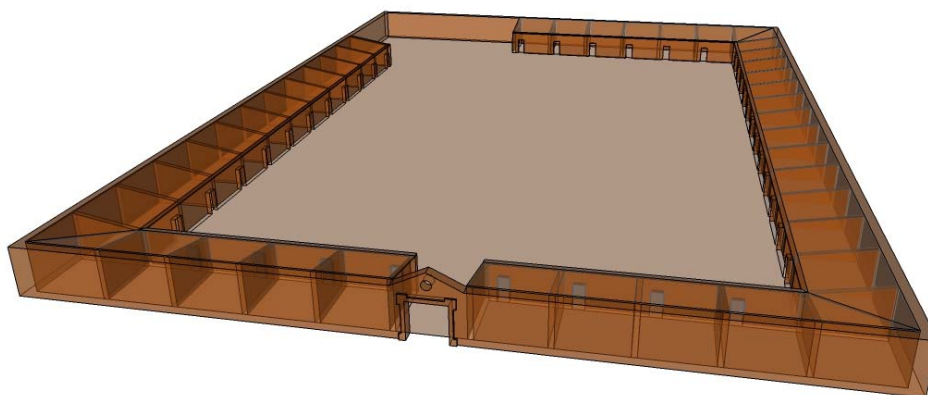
Reconstrucción Virtual Sector 6: La Ranchería
